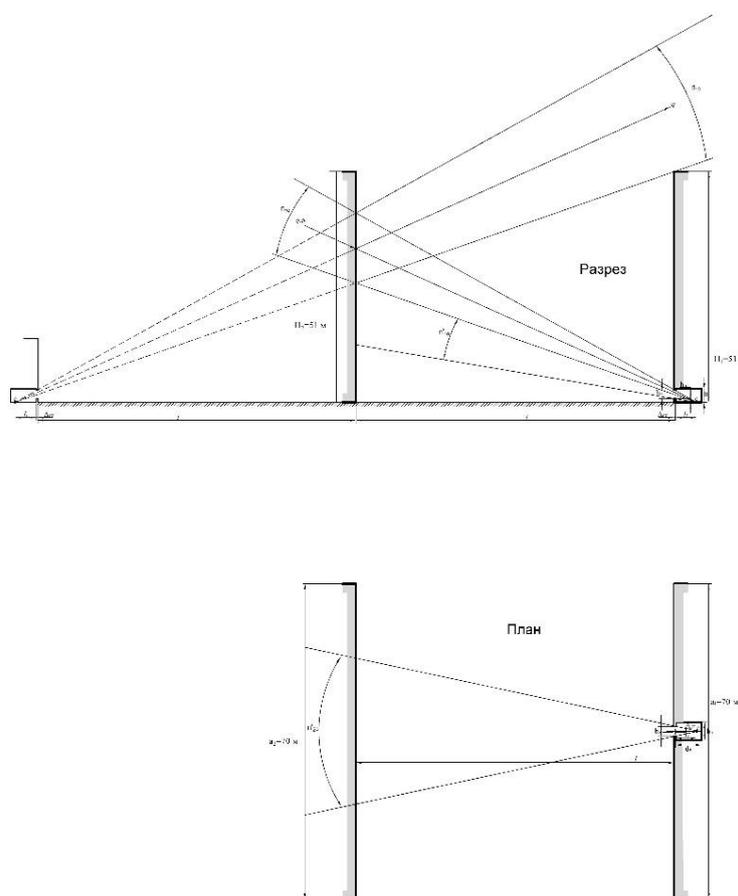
Разрез и план с видимыми из расчетной точки помещения зеркально отраженными участками небосвода и участков фасада проектируемого здания в фасаде противостоящего здания
